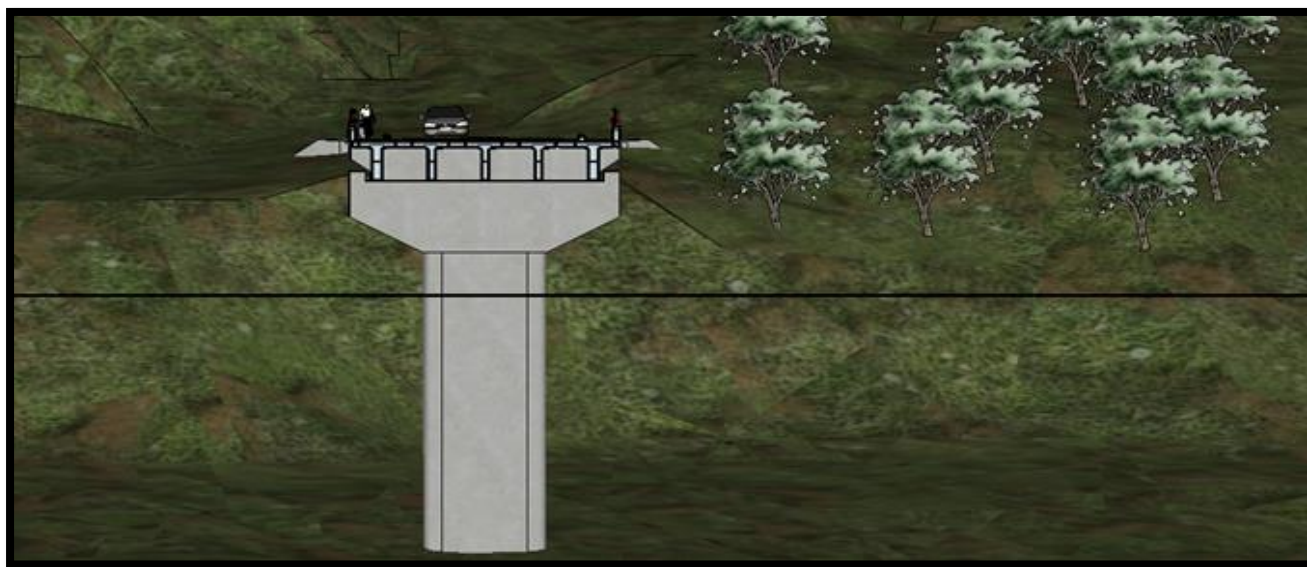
Puente Telpaneca, corte de superestructura, observación de pila
